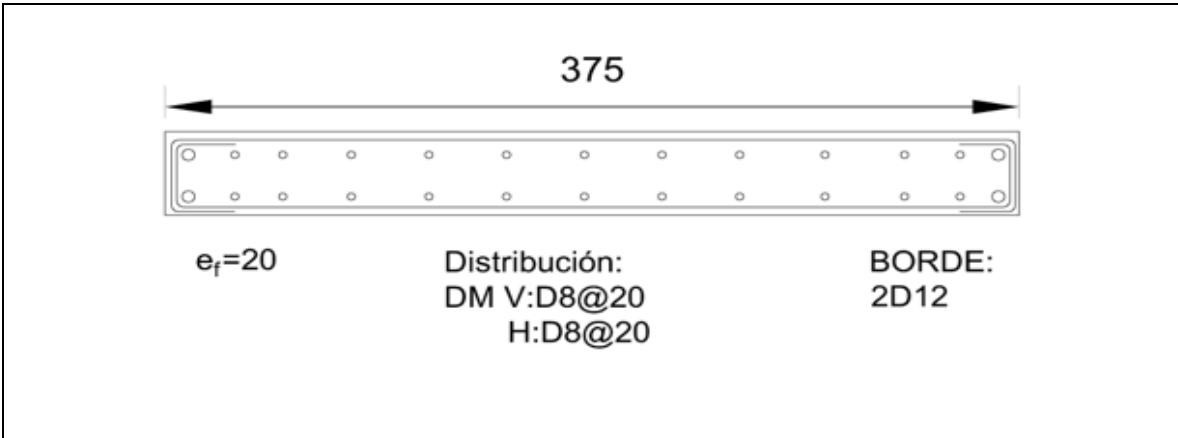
Refuerzo horizontal y longitudinal muros R
